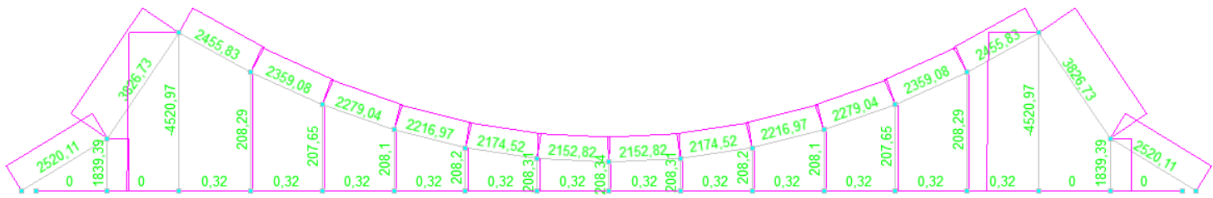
Эпюра усилий N от расчетной нагрузки (кН)
